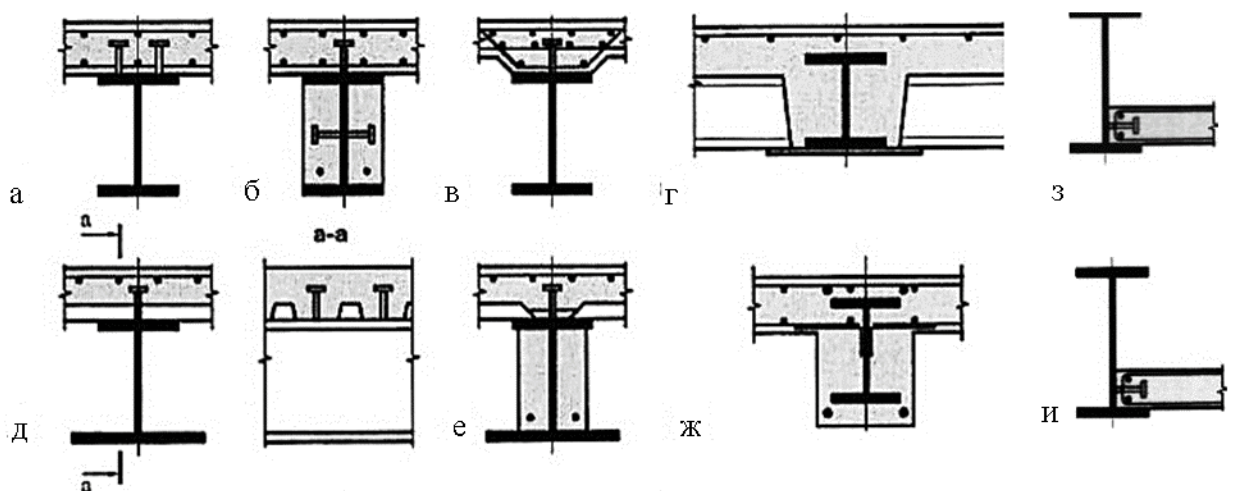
Типи компоновки перерізу комбінованих балок; а), в), д) – з обетонуванням стиснутої зони сталевих балки; б), е), ж) – з обетонуванням всього перерізу сталевих балки; з), и) – з обетонуванням розтягнутої зони сталевих балки
